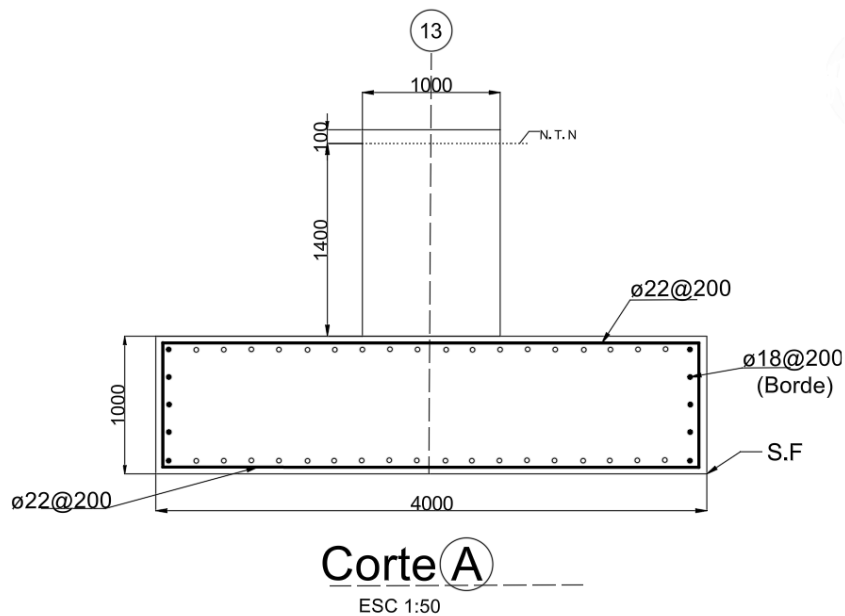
Corte A (Eje 13) para la geometría y armadura de las zapatas
